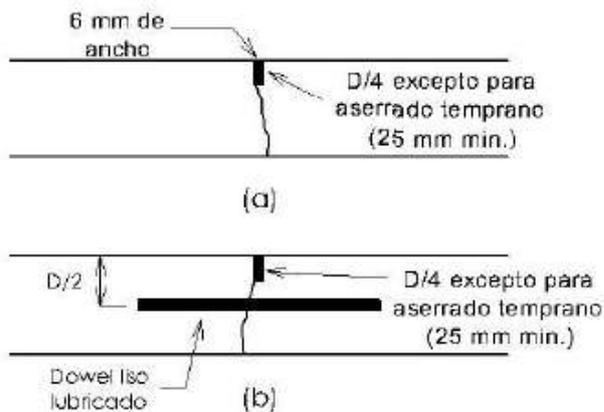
Tipos de Juntas Transversales de Contracción
